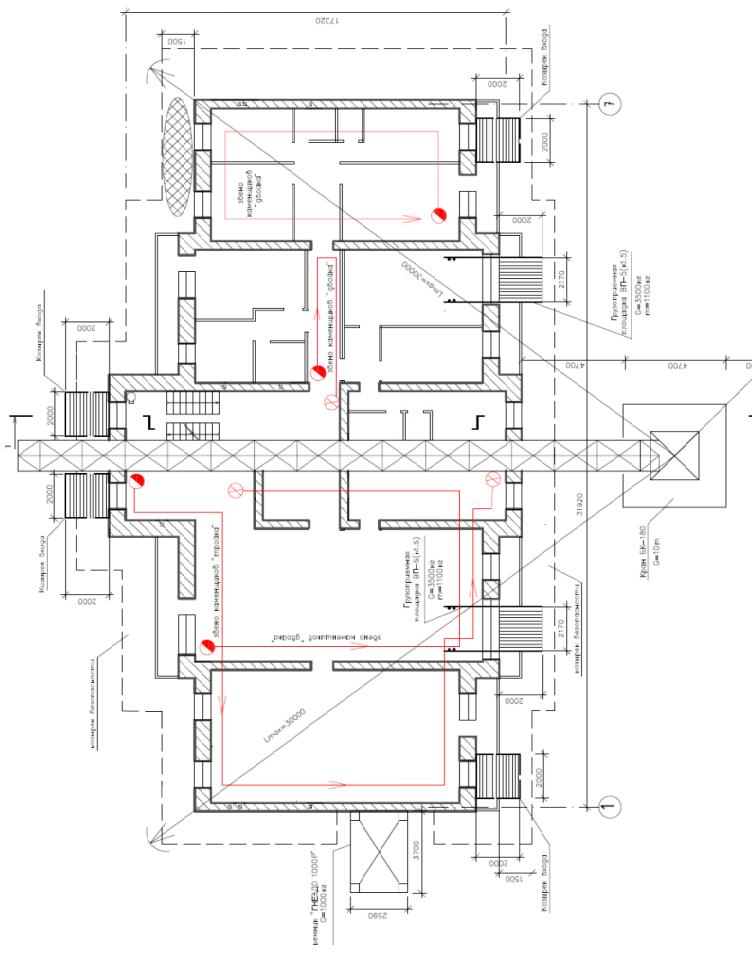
Схема размещения выносных грузоприемных площадок со стороны монтажного крана, а также размещения козырьков входов и пятачных козырьков (выполнена студентом В.Н. Снигирева, гр. ПГС-12-1)
